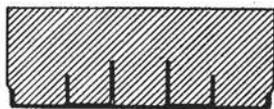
Palplanches en béton de la firme Hoesch/Kolster.
